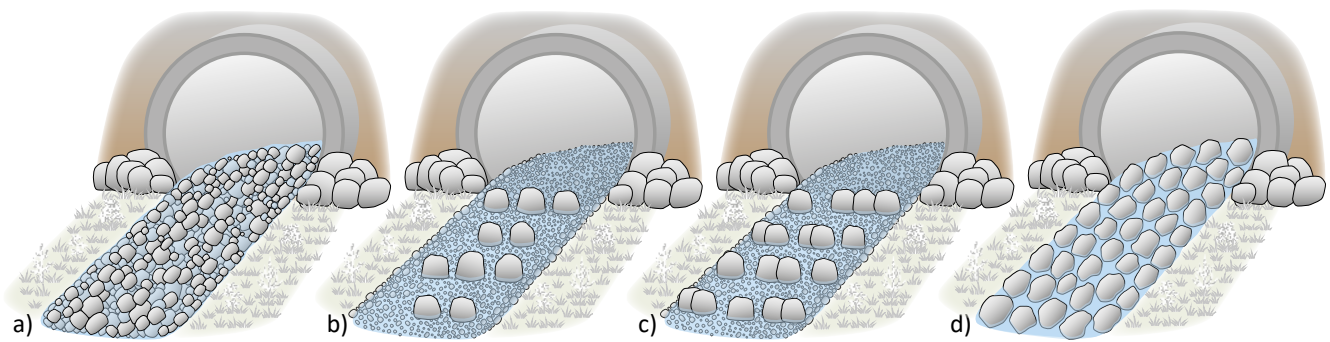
Skizzierung verschiedener Rampenbauweisen: a) geschüttete Rampe, b) gleichmäßig verteilte Einzelblöcke, c) lückige Querriegel, d) gesetzte Rampe. (verändert nach ²⁹)
